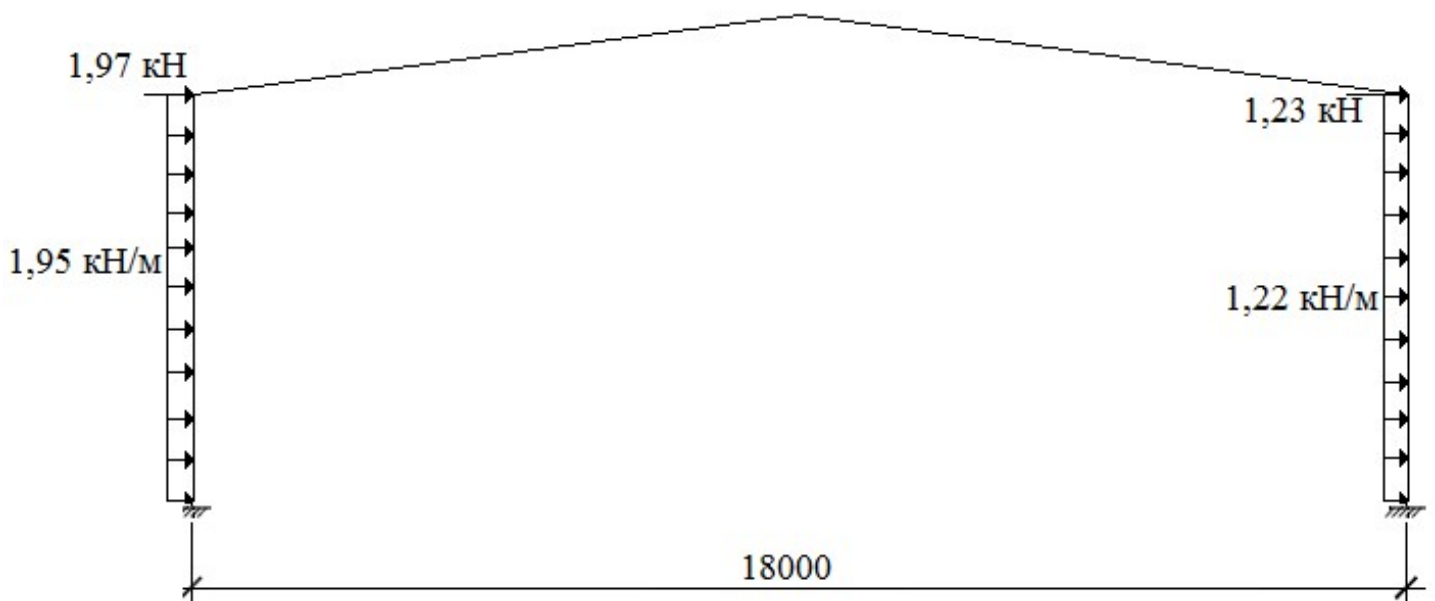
Схема загрузки от ветровой нагрузки слева здания
